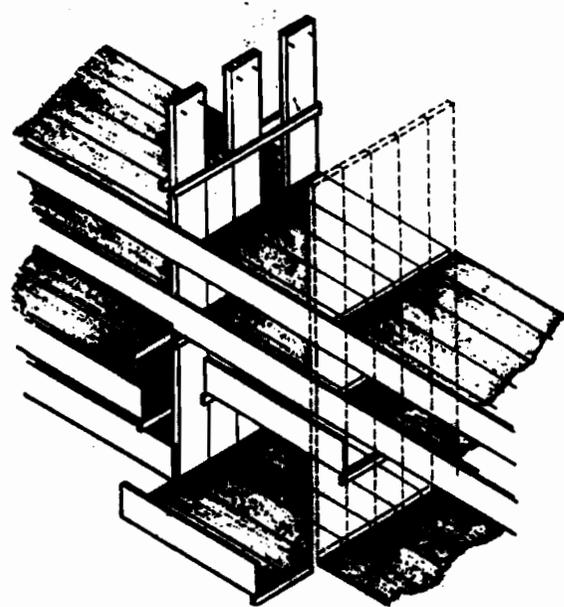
Sistema constructivo LM. Arquitectos A. Mata, C.M. Gutiérrez y P. Jacob. 1972-1978.
